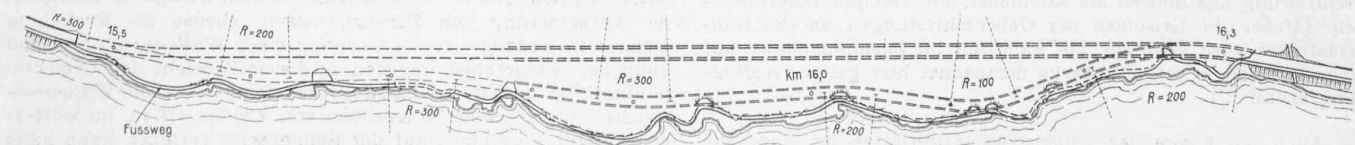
Lageplan, Masstab 1 : 5000, von Km. 15,5 bis Km. 16,3: Tunnel mit Fenstern und langer, gerader Tunnel ohne Fenster.
